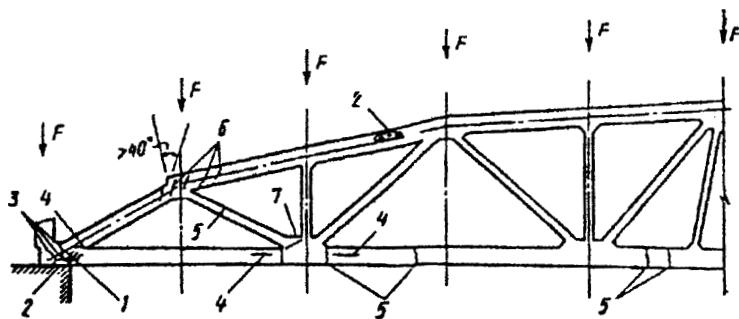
, в. Характерные повреждения в железобетонных фермах с нижним предварительно напряженным поясом:
